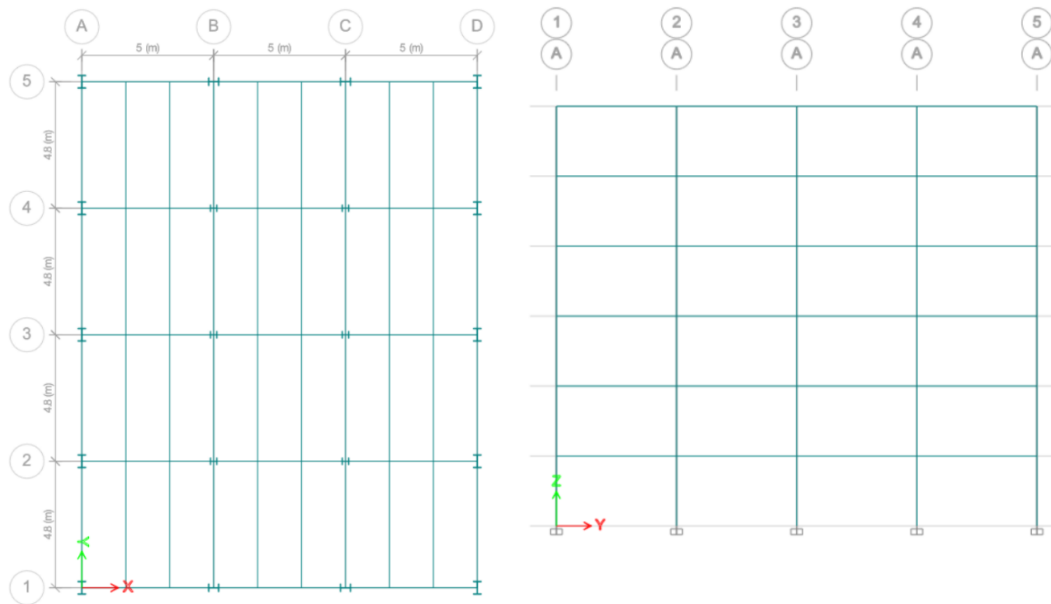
Esquema en elevación y en planta para el edificio de análisis.
